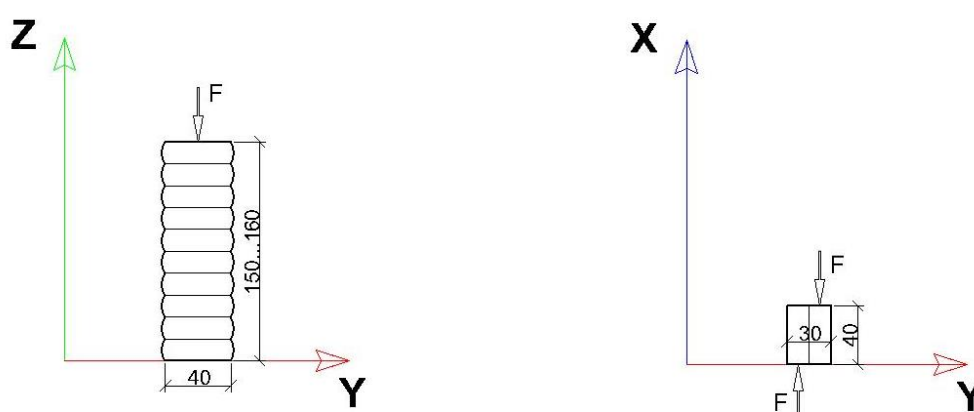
Схема испытаний образцов, выпиленных из 3D-печатной конструкции
